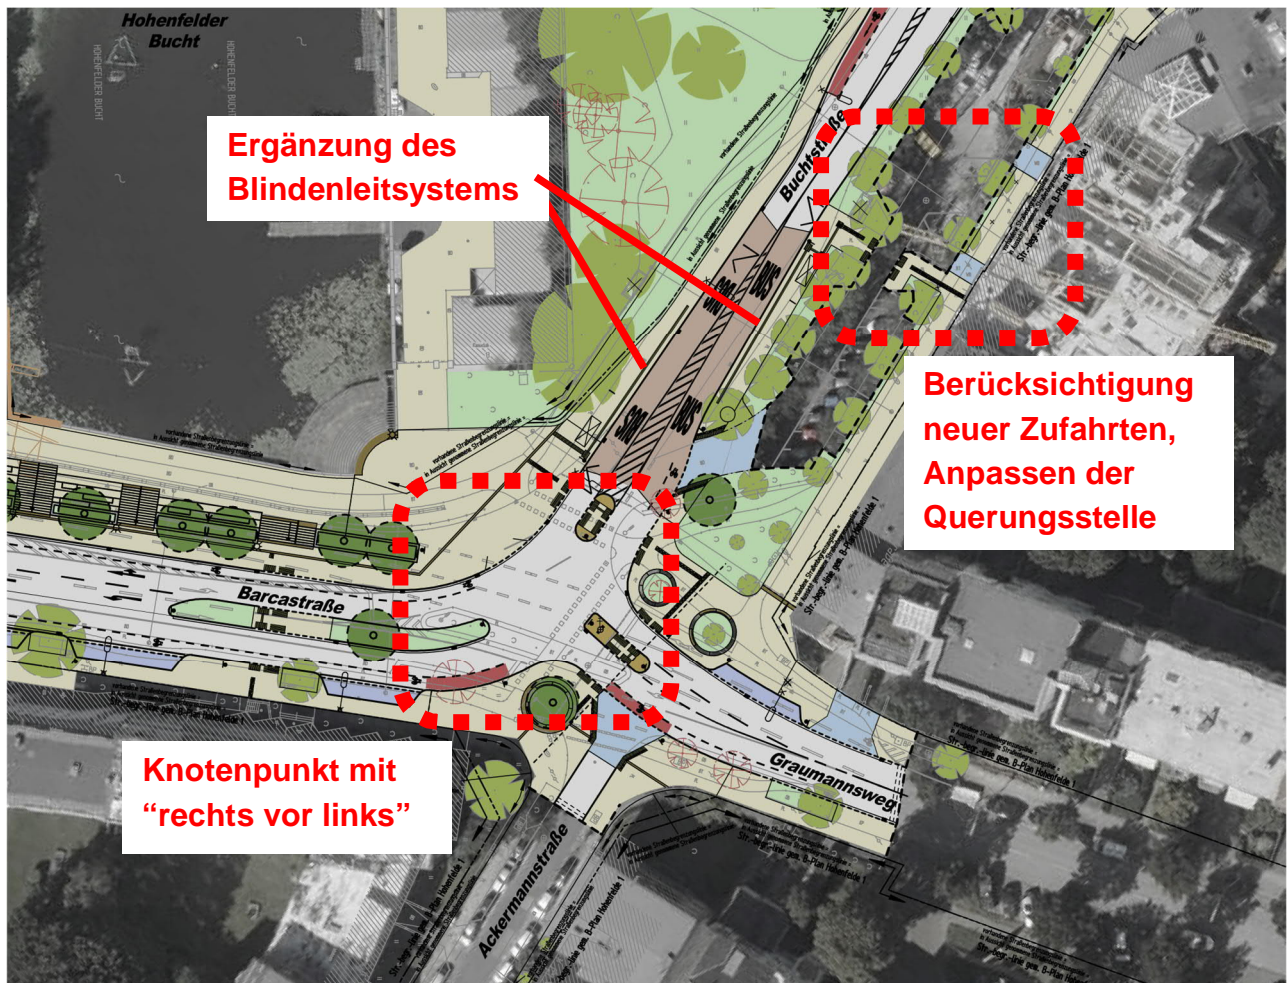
Lageplan-Ausschnitt mit Knotenpunkt Sechslingspforte / Barcastraße
